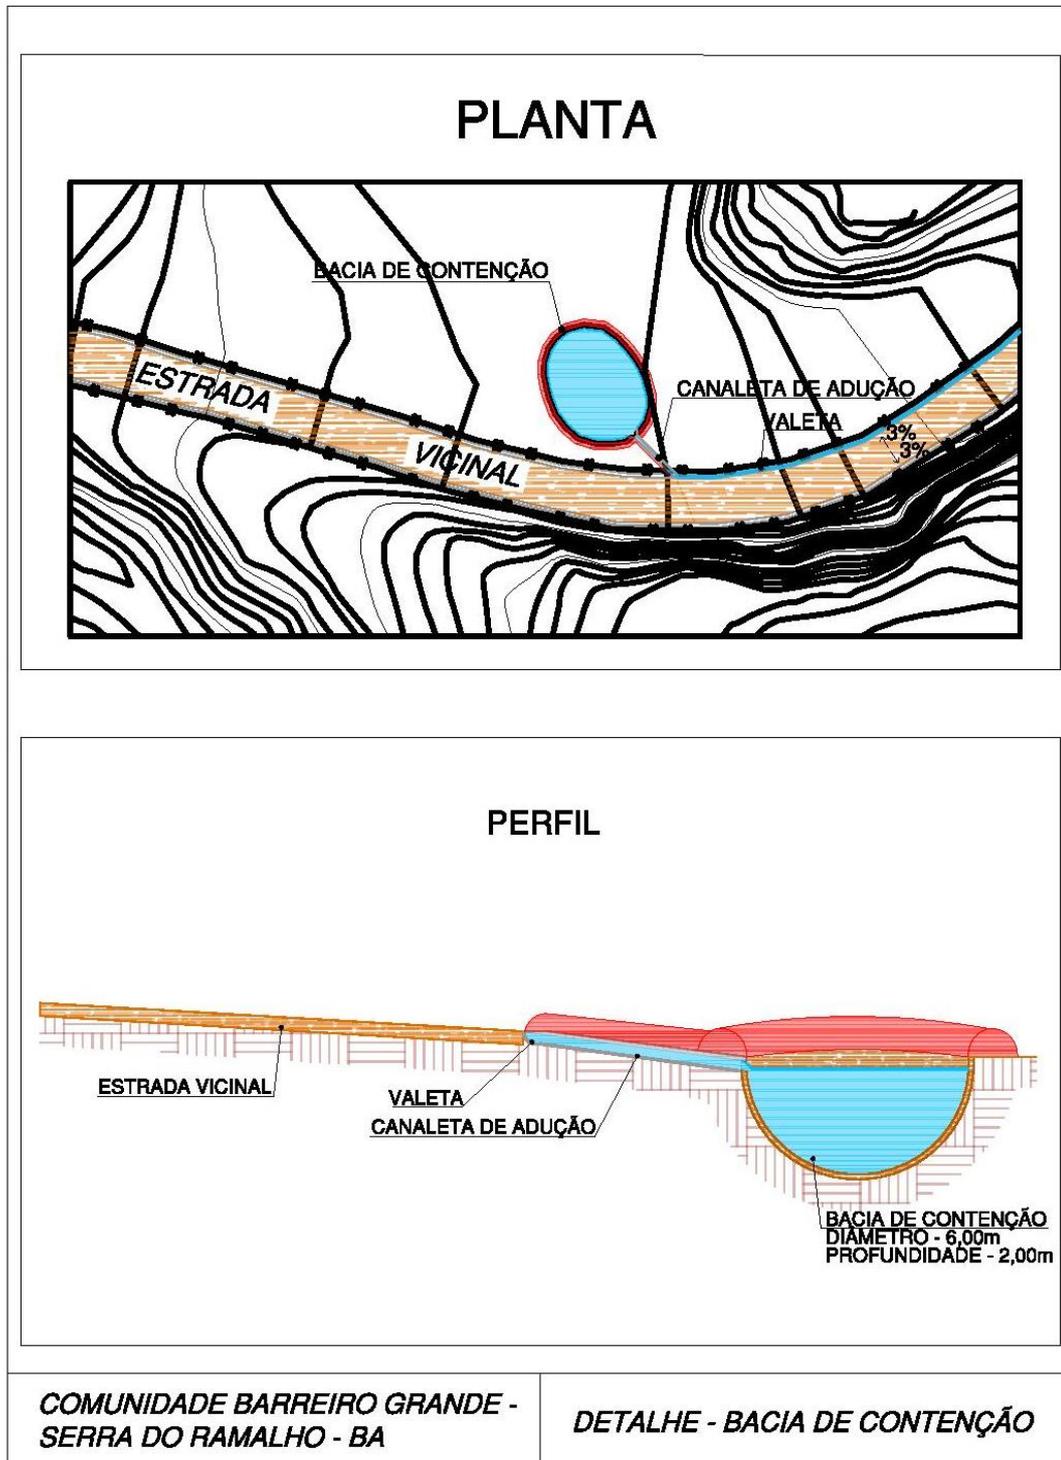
Planta e perfil de bacia de contenção de águas pluviais
